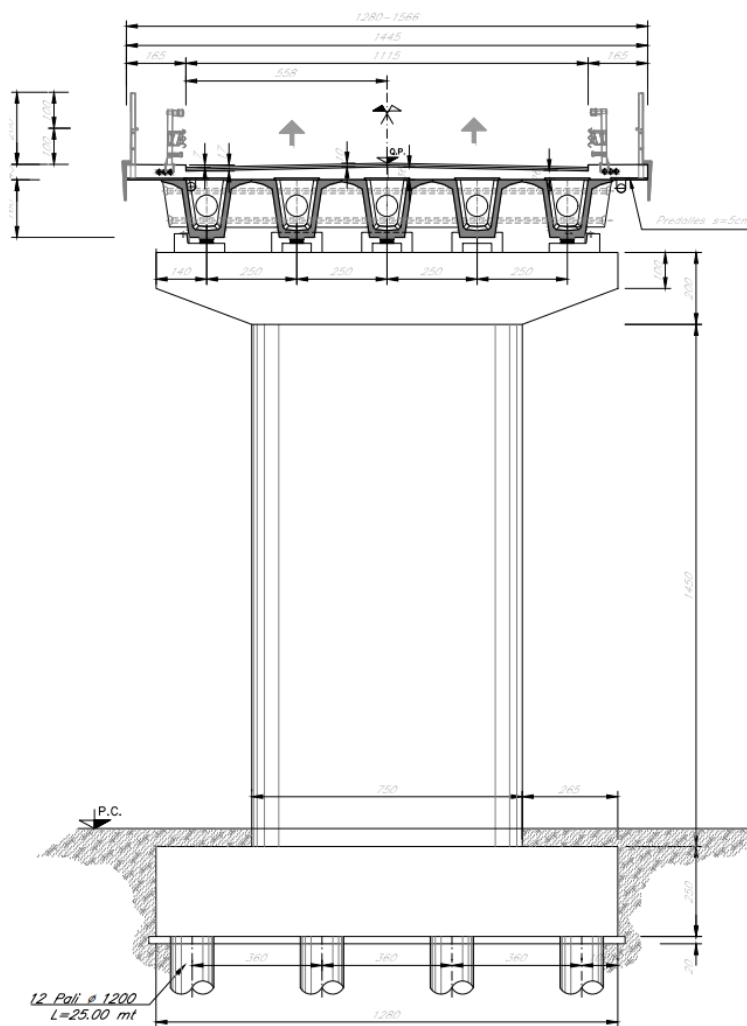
Sezione longitudinale nuovo cavalcaferrovia S.P.93
